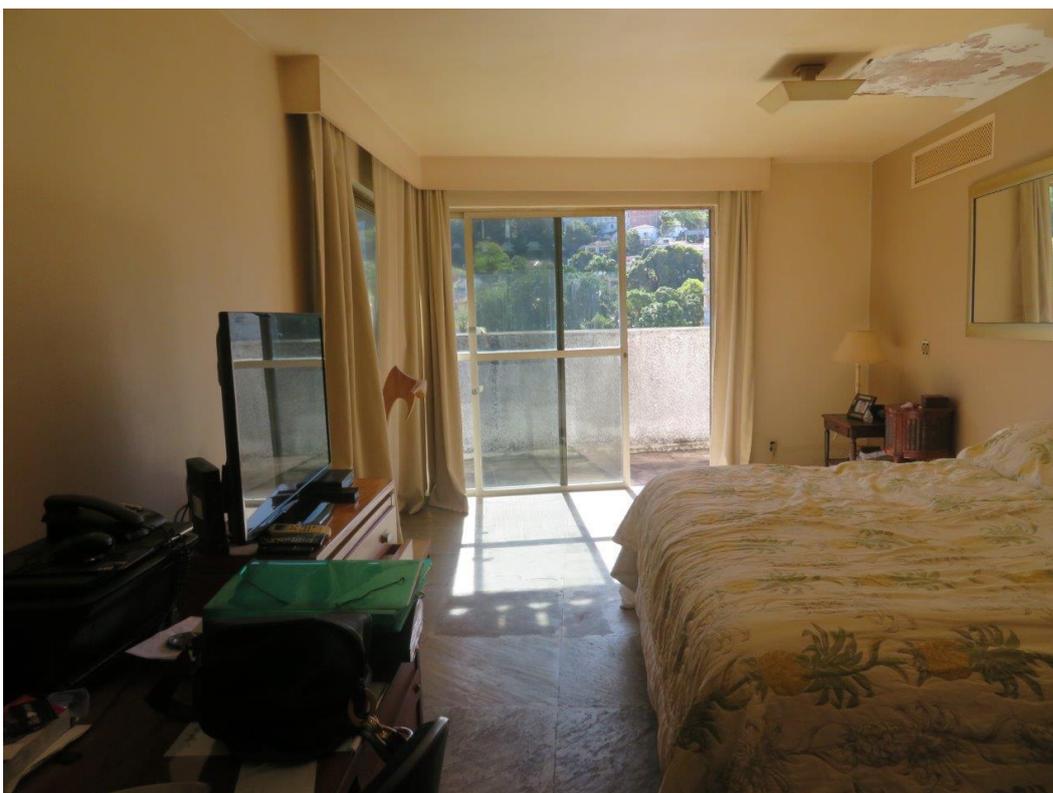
I – Suíte principal – vista da varanda. Mau estado do revestimento do guarda-corpo.
